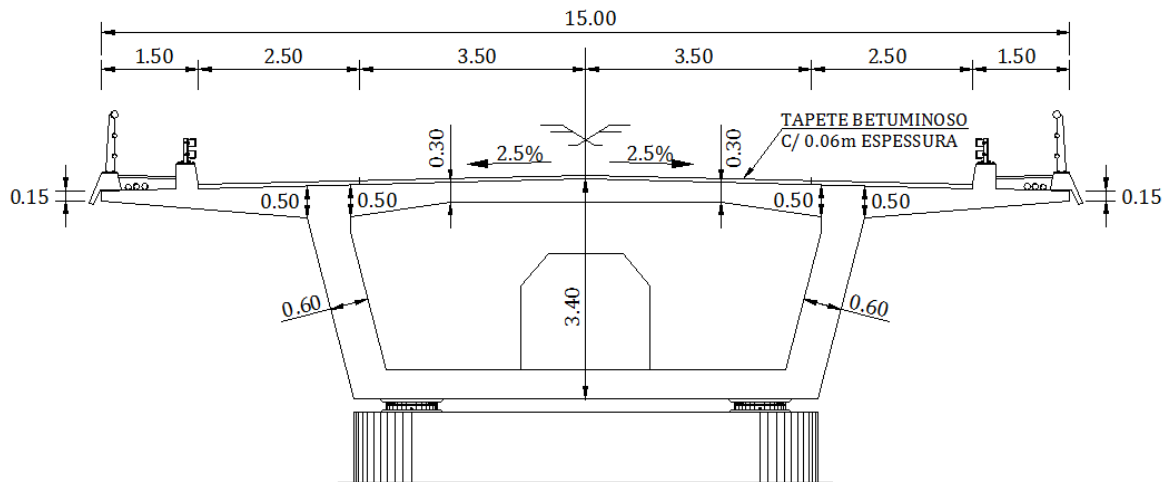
Secção transversal junto ao apoio nos pilares (caso de estudo 3)
